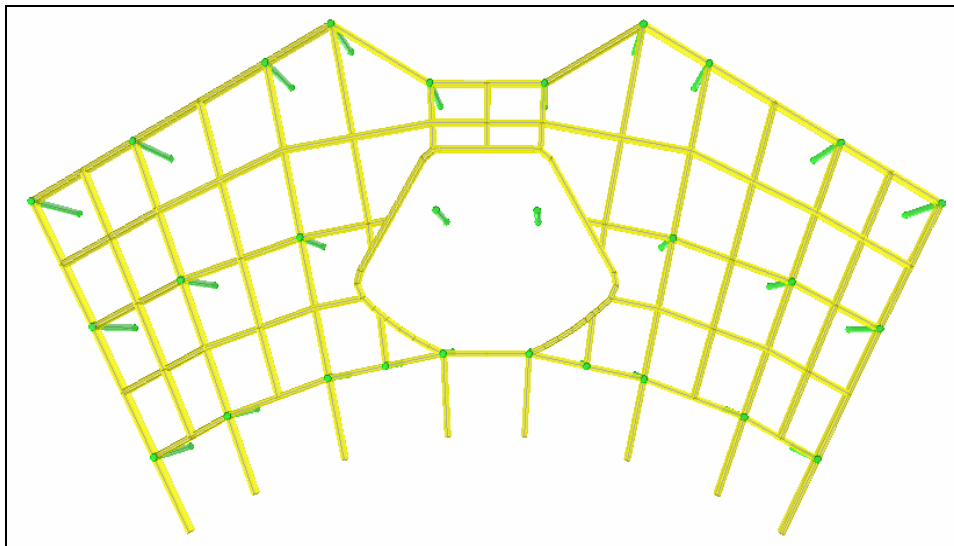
Distribución de vigas y columnas para la platea alta.
